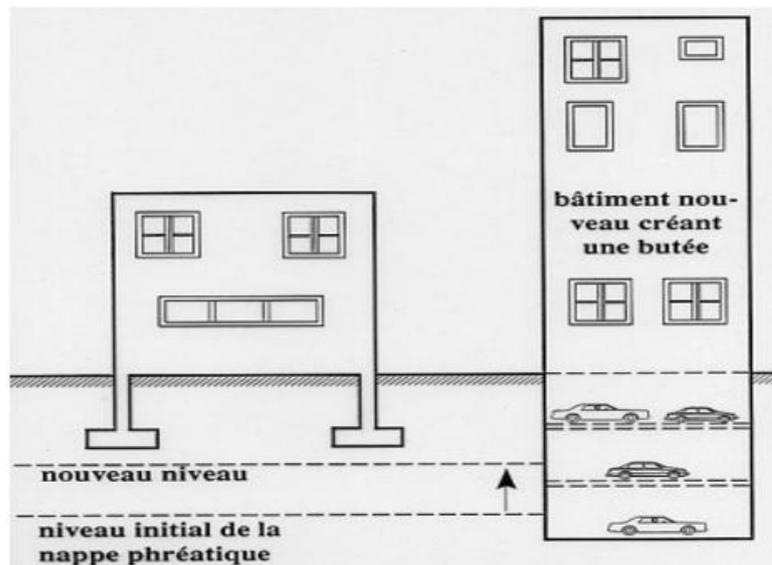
Modification du niveau de la nappe par une butée aux eaux de ruissellement.
